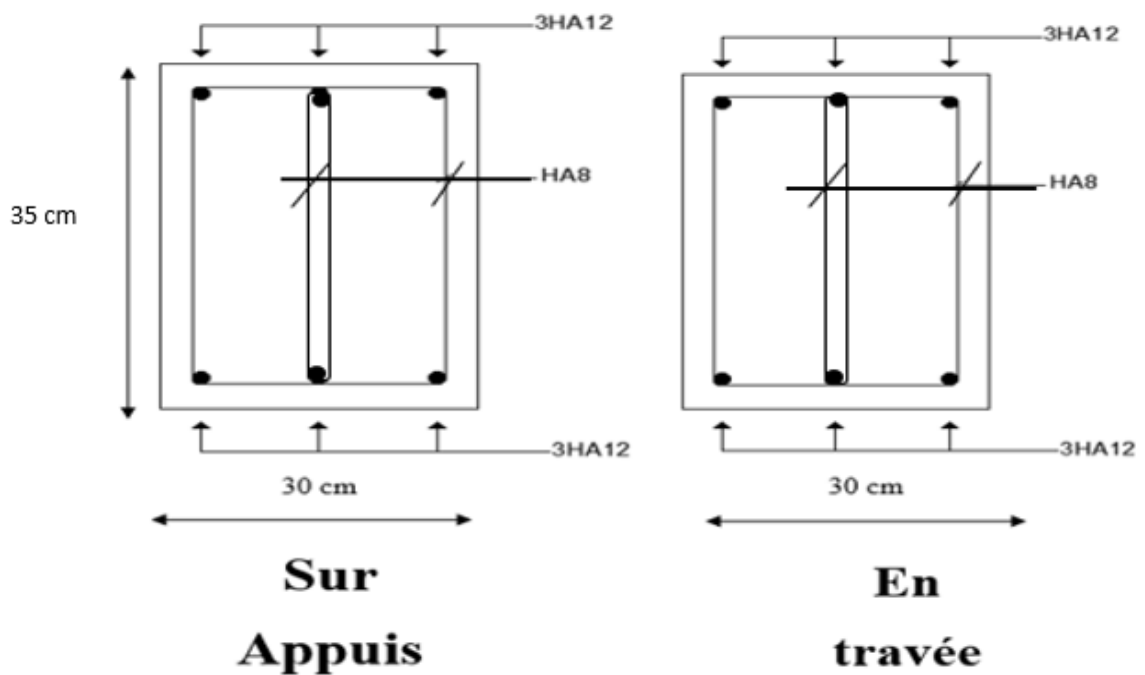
Schémas de ferrailage des poutres secondaires en appuis et travée (Etage courante)
